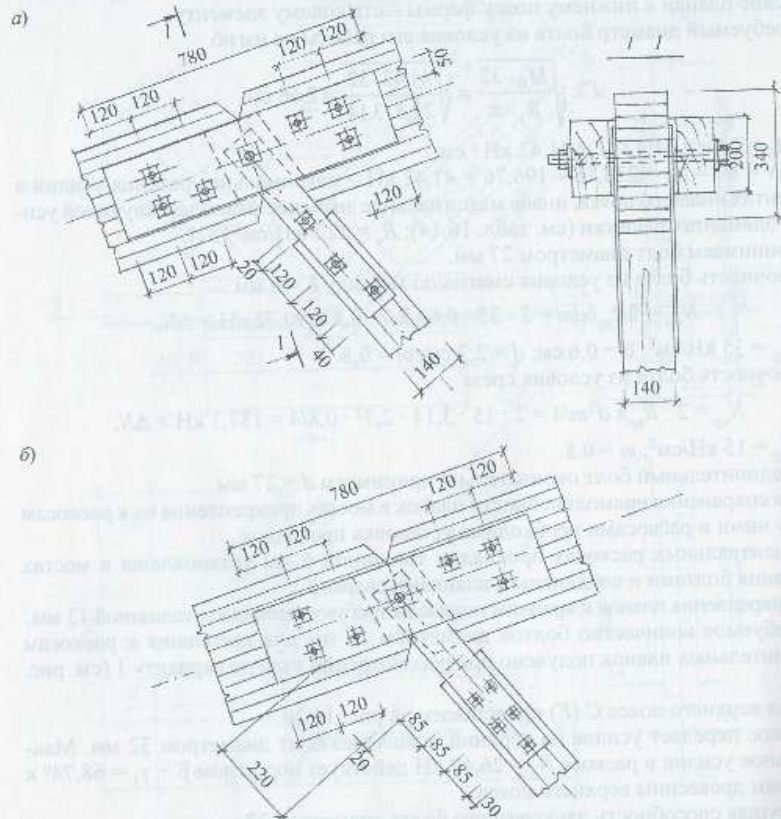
Варианты узла C верхнего пояса: а – с присоединением раскоса болтами; б – то же, глухими винтами
